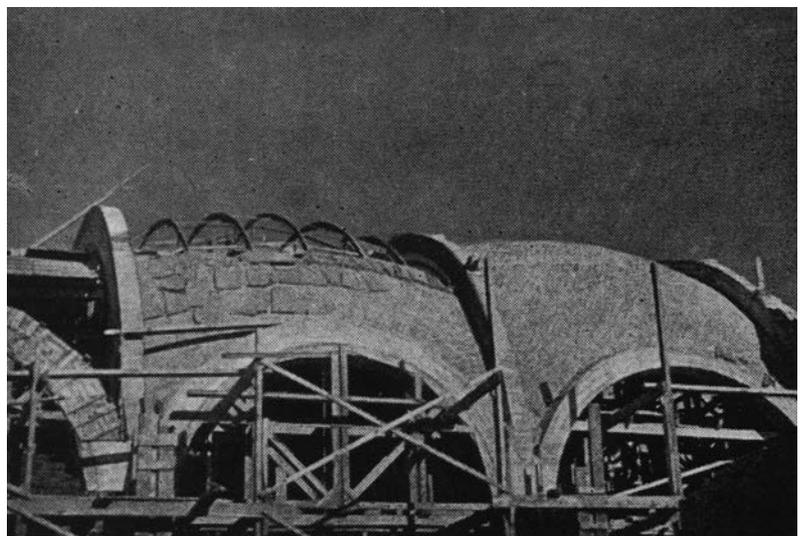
Vista de las bóvedas de la nave durante su construcción.
